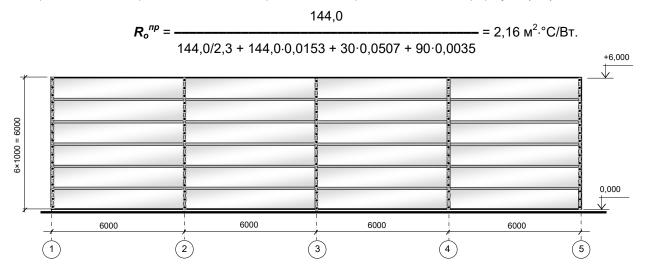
Схематичный фасад производственного здания (к примеру расчета И.1)
